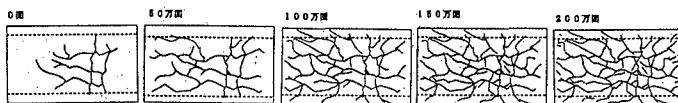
(D-RAP補強床版のひび割れ状況)
